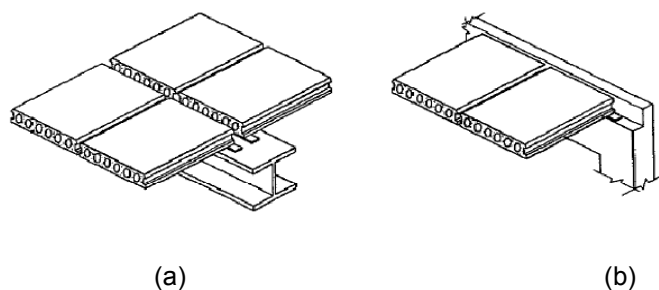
Ligação laje - viga: (a) viga metálica, (b) viga com abas laterais (extraída de [6])
